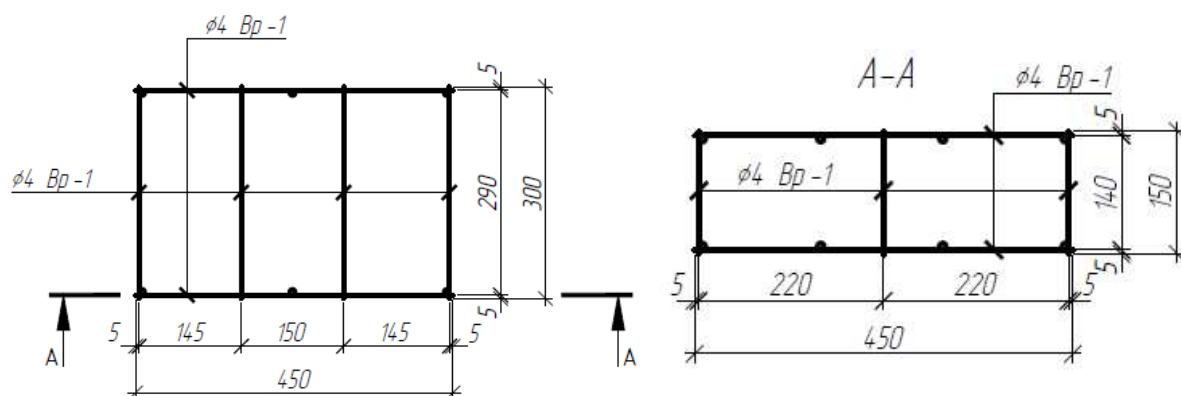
Схема армування залізобетонної плити 450×300×150 мм
